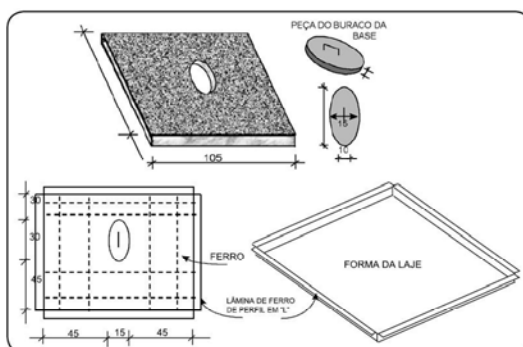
Laje de Concreto para Piso de Privada (medidas em “cm”).
